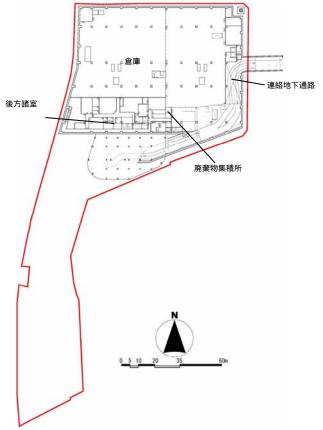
(2) 各階平面図(地下1F)(変更前:評価書)
